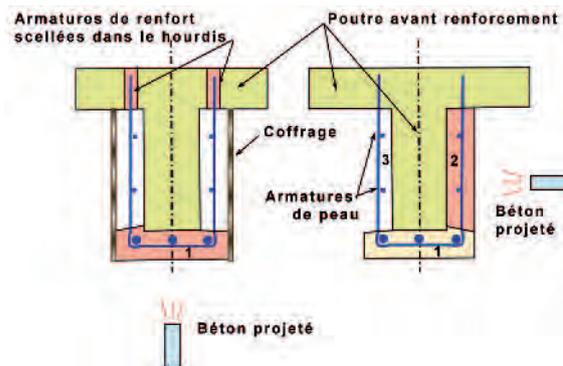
exemple de renforcement avec ajout de béton et d'armatures
